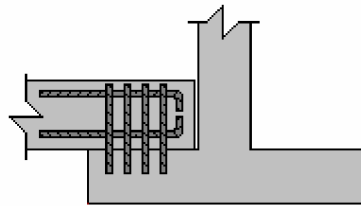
Apoyo de la viga de enlace en la zapata central.
